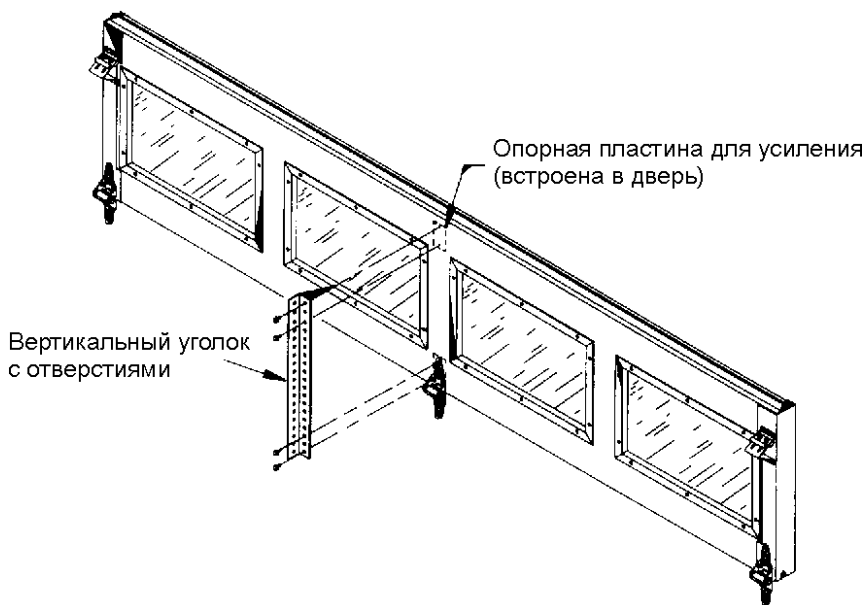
Крепление опорной пластины для установки открывателя двери (Cloray)
